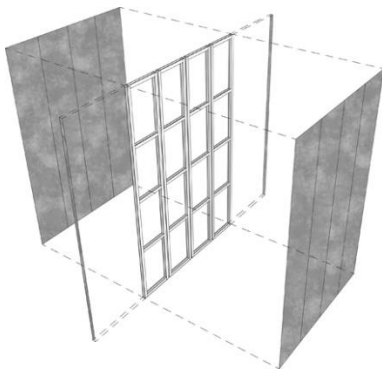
Esquema construtivo da estrutura dos painéis deslizantes
